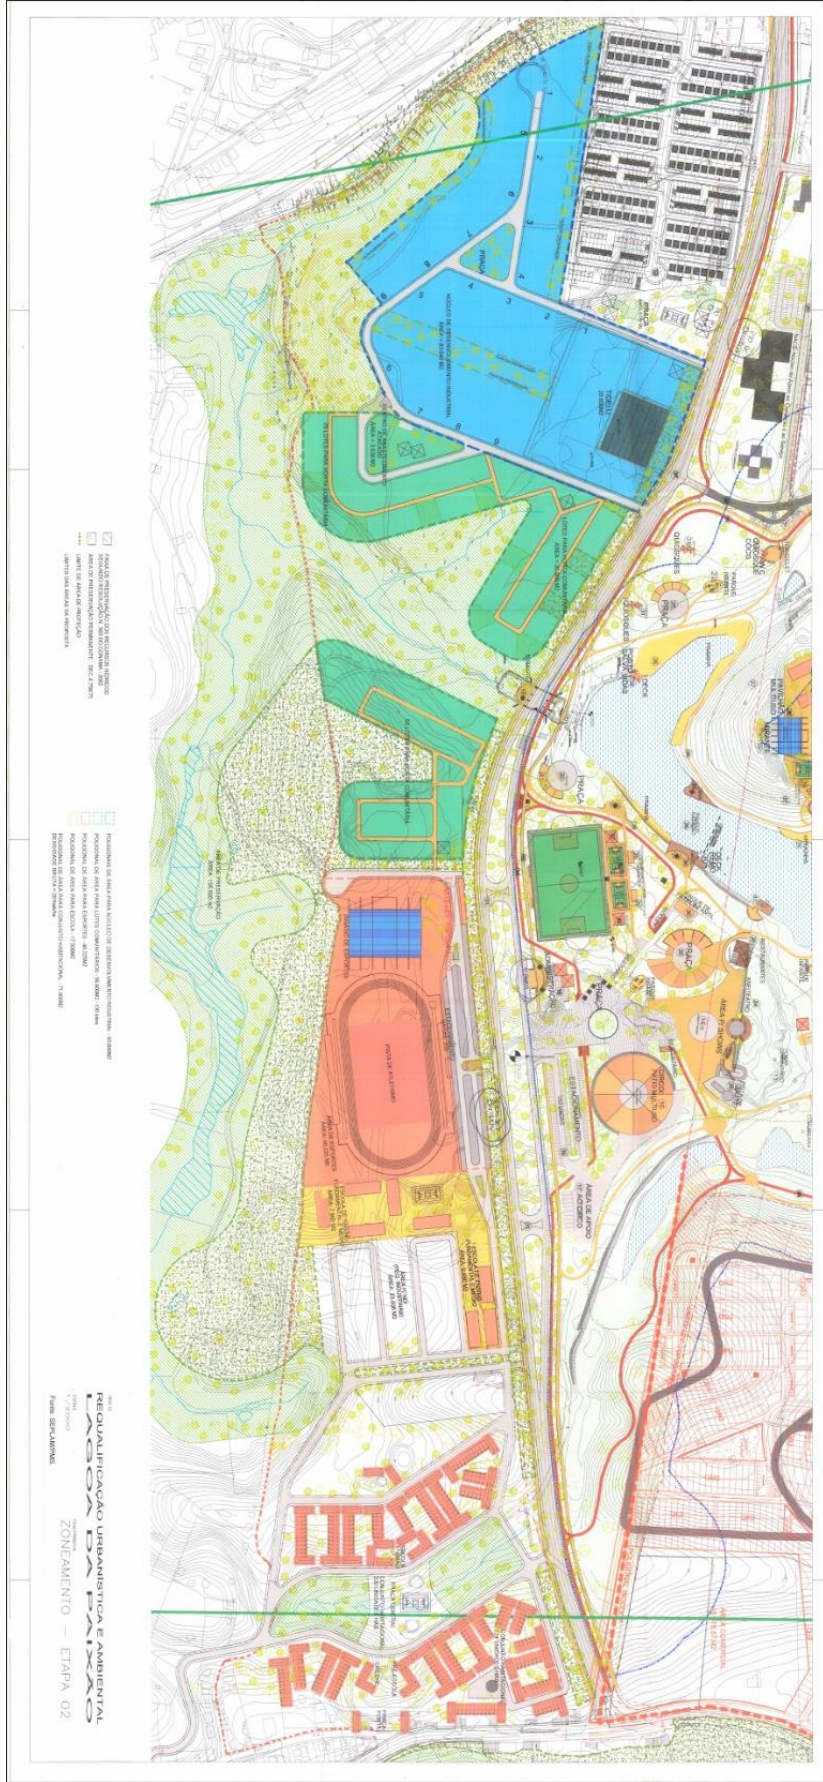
Planta de Requalificação Urb Lagoa Paixao
